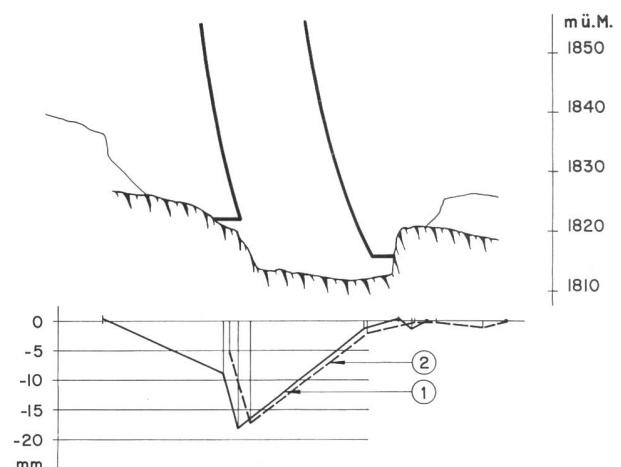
Fundamentsetzungen der Staumauer Sta. Maria
